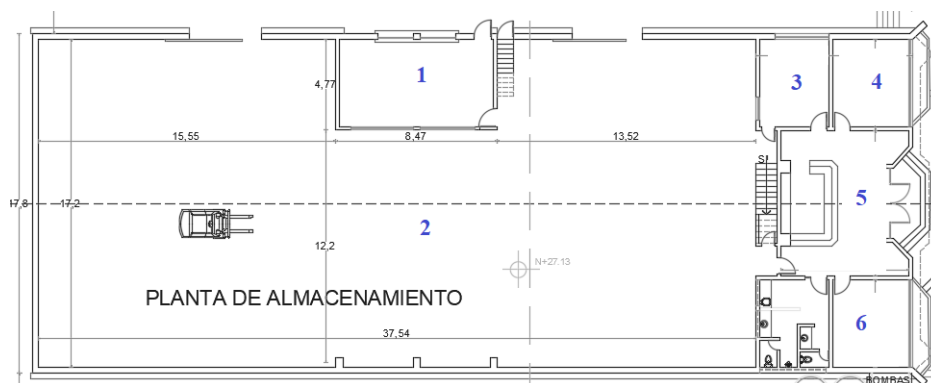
Área 3: Planta de almacenamiento (planta baja)
